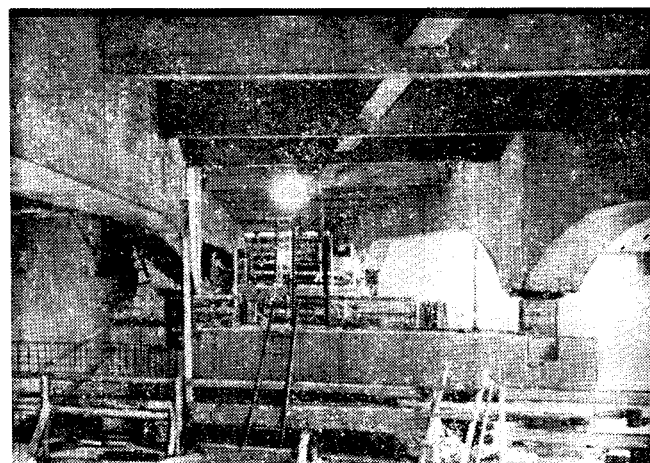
Пролетное строение, опирающееся на опорные клеточки из бетонных плиток
